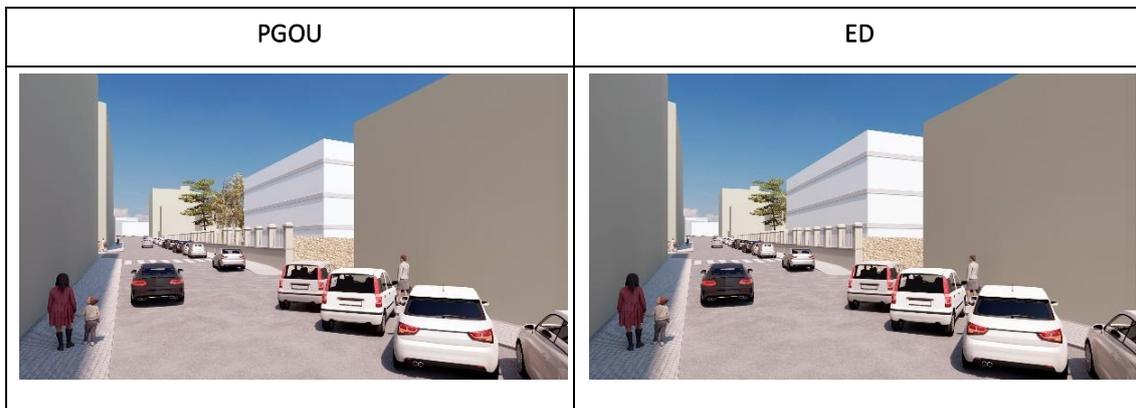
Vistas desde la C/ Carmen Roca en dirección norte del PGOU vigente y de la propuesta del ED.
